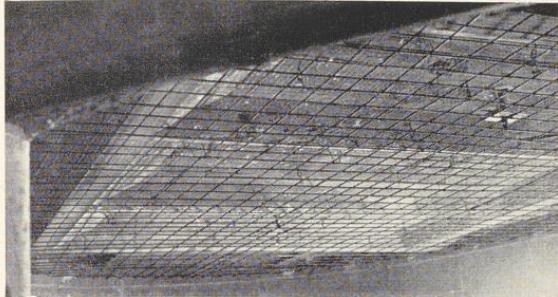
An Eisenbetondecke aufgehängte Rabitzkonstruktion
